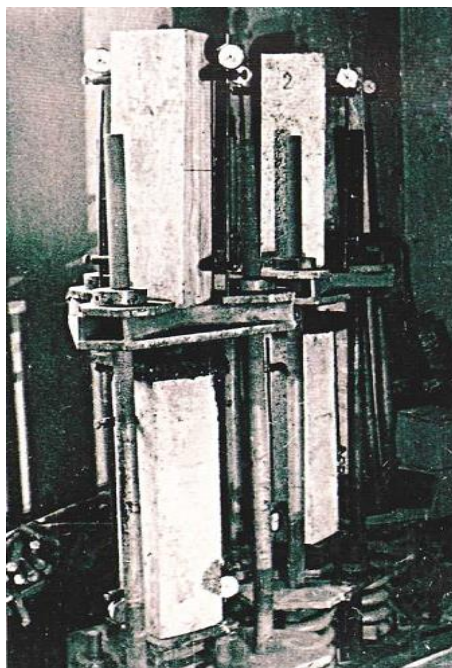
Пружинная установка для испытания арболитовых призм-образцов под длительной нагрузкой
